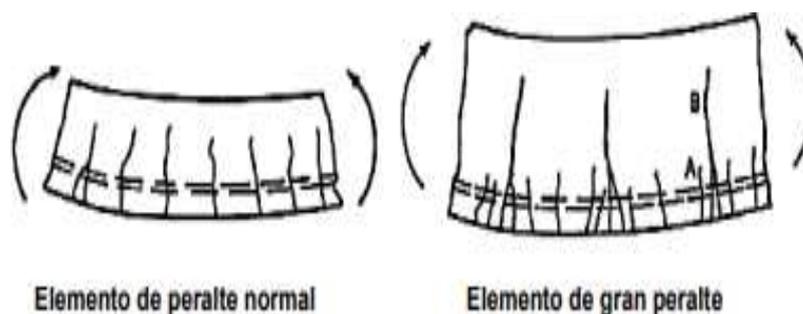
Grietas por esfuerzos de tracción por flexión del concreto. [52]
